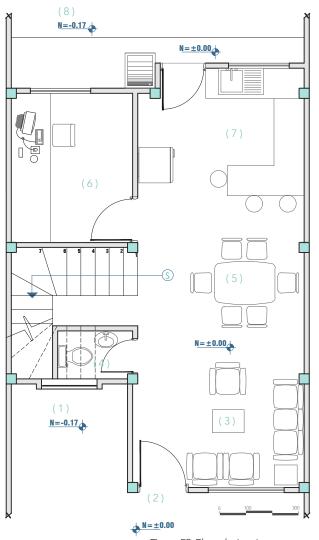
Planta baja primera estapa Nota: Elaborado por el autor
